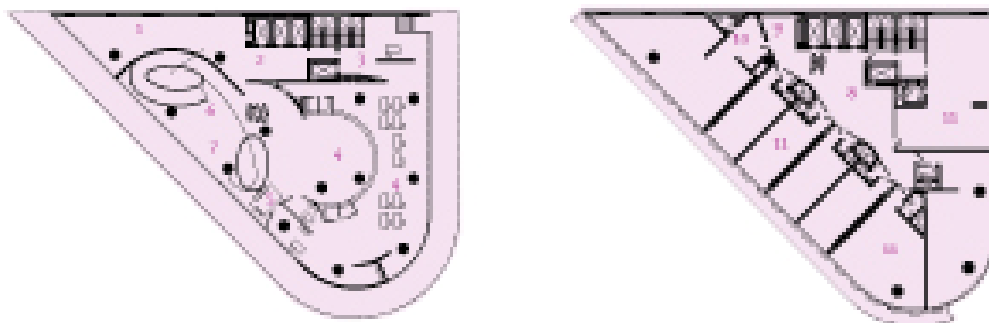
Sede do Banco Mineiro da Produção – 1953 – Belo Horizonte. Projeto: Oscar Niemeyer. Cálculo estrutural: Werner Müller. Os pilotis são mantidos afastados da fachada, ou desaparecem nas paredes divisórias do pavimento tipo. Fonte: Macedo, 2008: 30.
